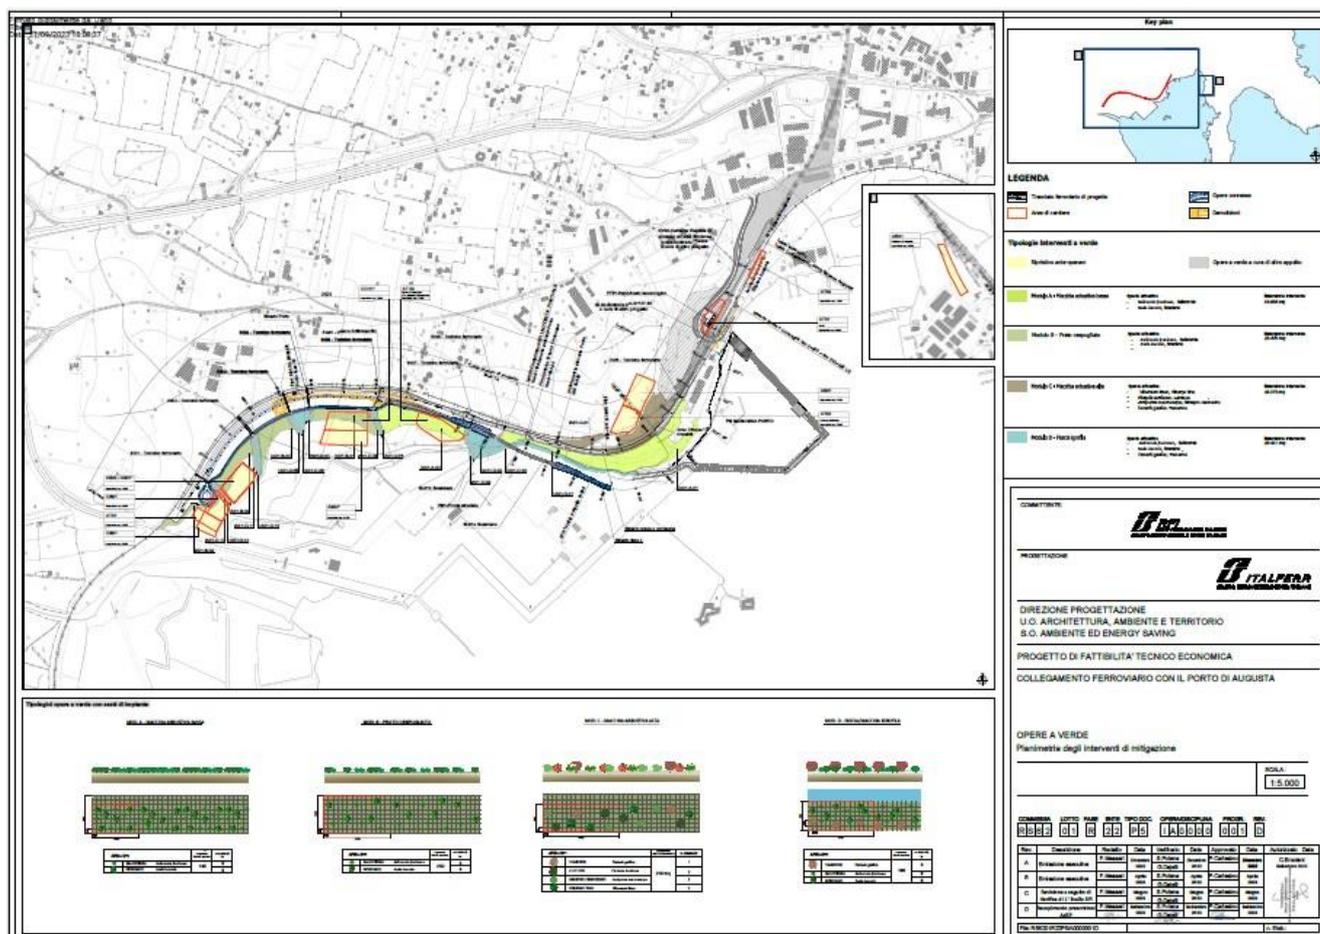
Elaborato "Planimetrie degli interventi di mitigazione " (tav. n. 243)
